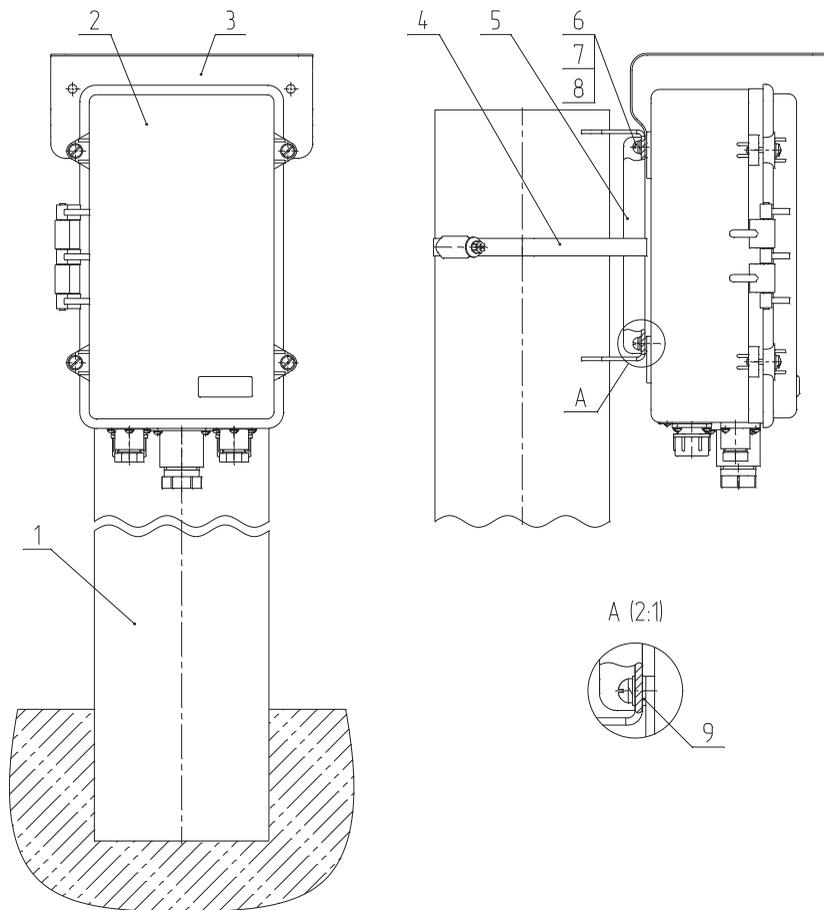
Крепление БЭ на ограждении из железобетонных плит или кирпичной стене
